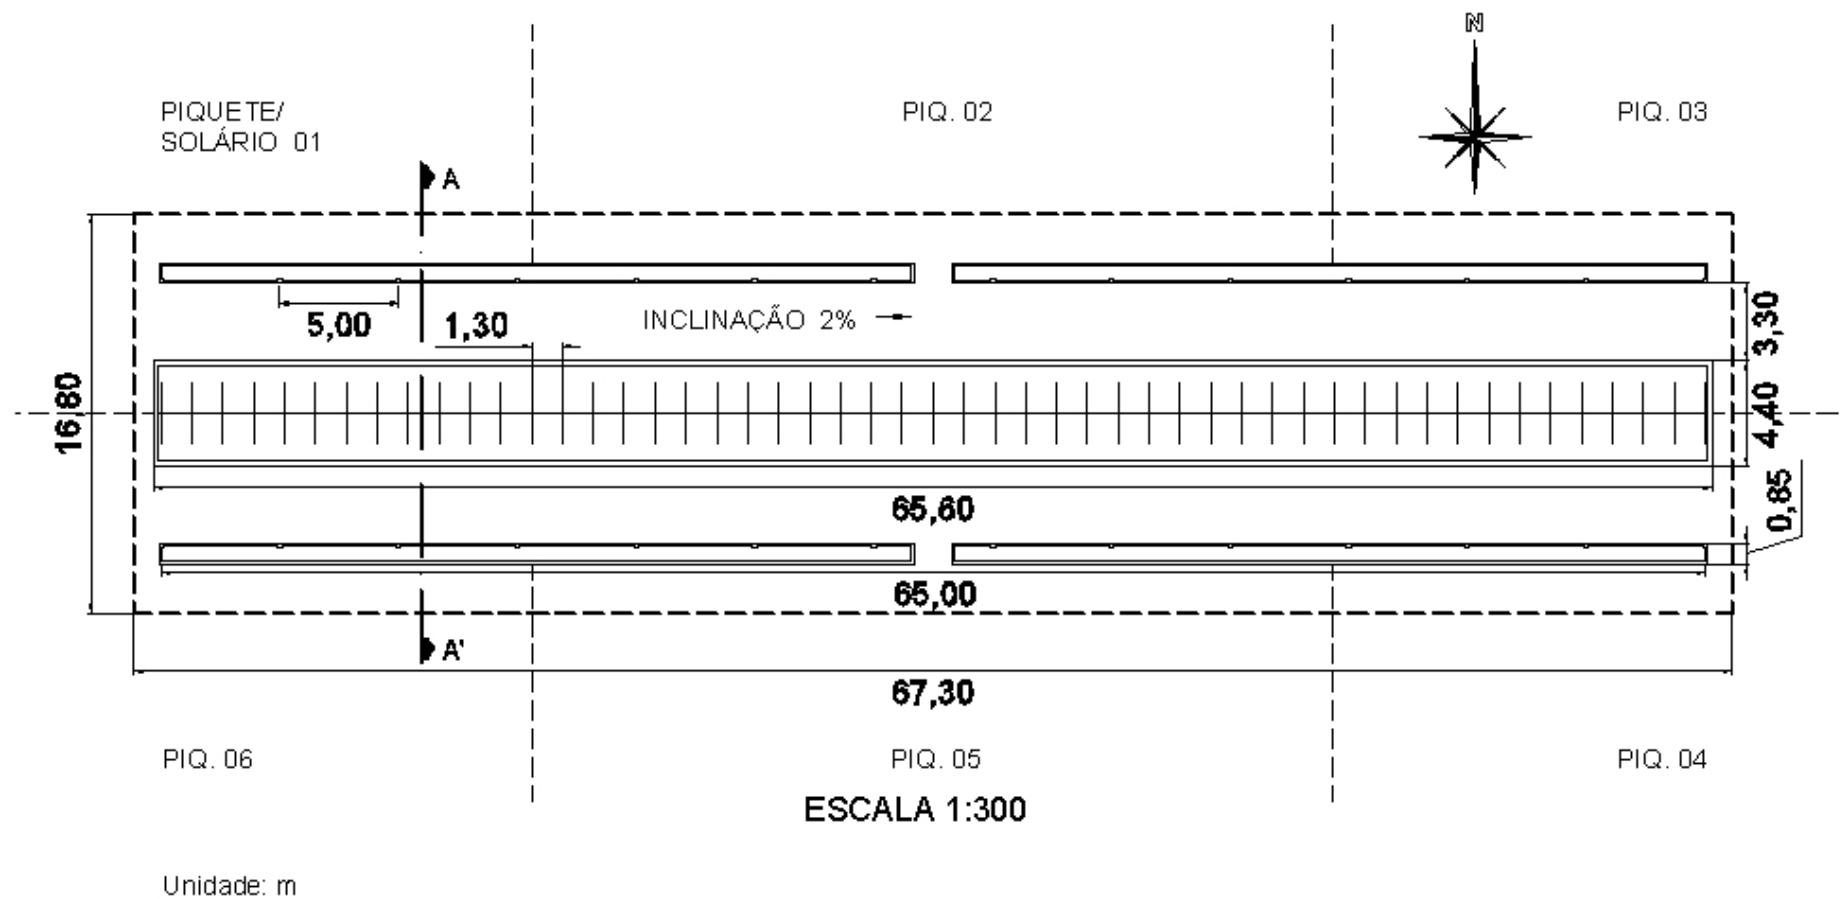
Planta Baixa do Galpão de Baias Livres Utilizado no Experimento.
